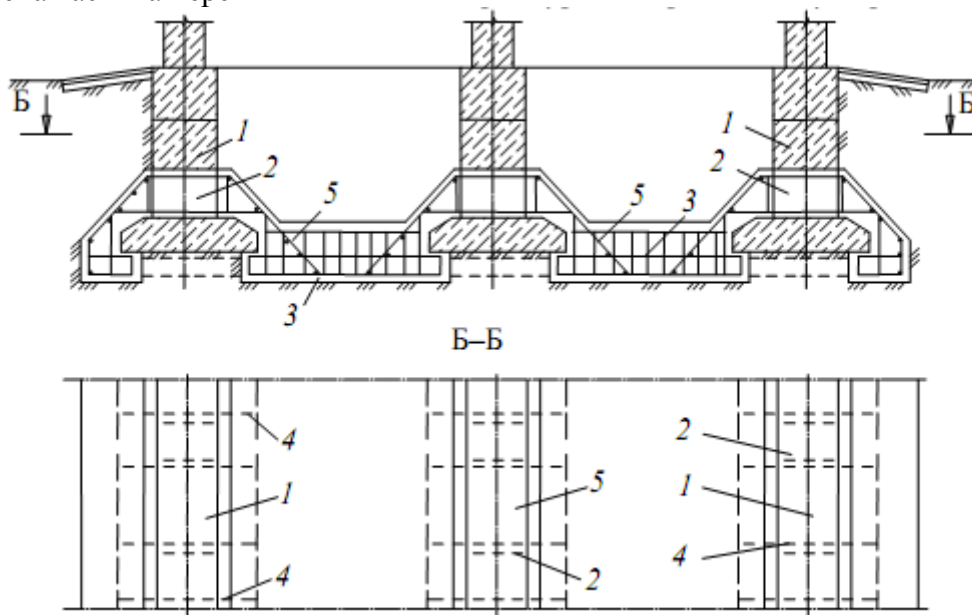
Перебудова стрічкових фундаментів в плитні:
